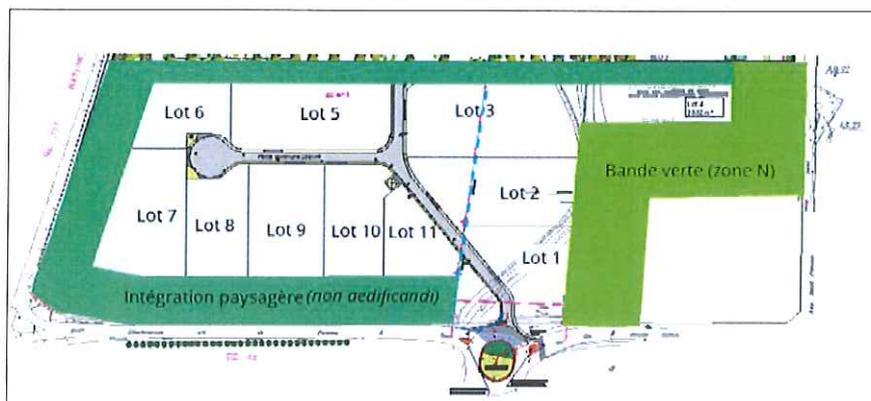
Plan masse du Projet d'aménagement de la ZAC des Trente (source : étude d'impact)
